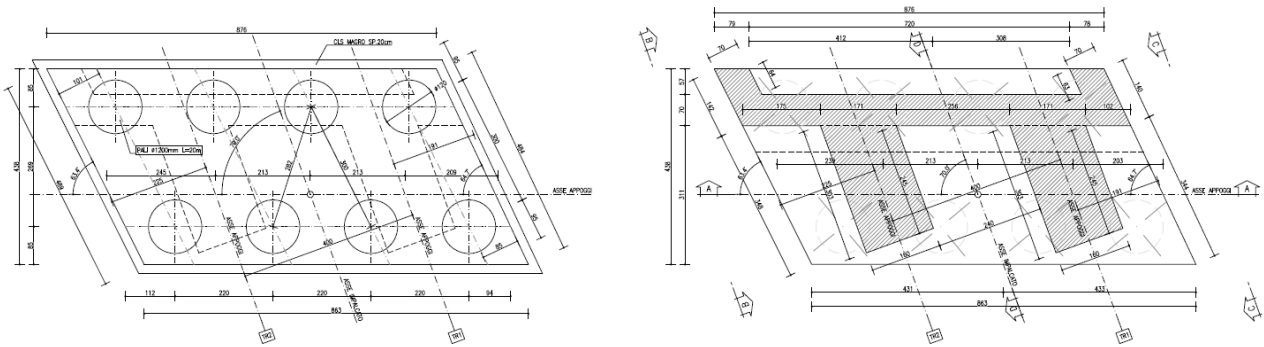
Spalla 1 – carpenteria fondazioni
